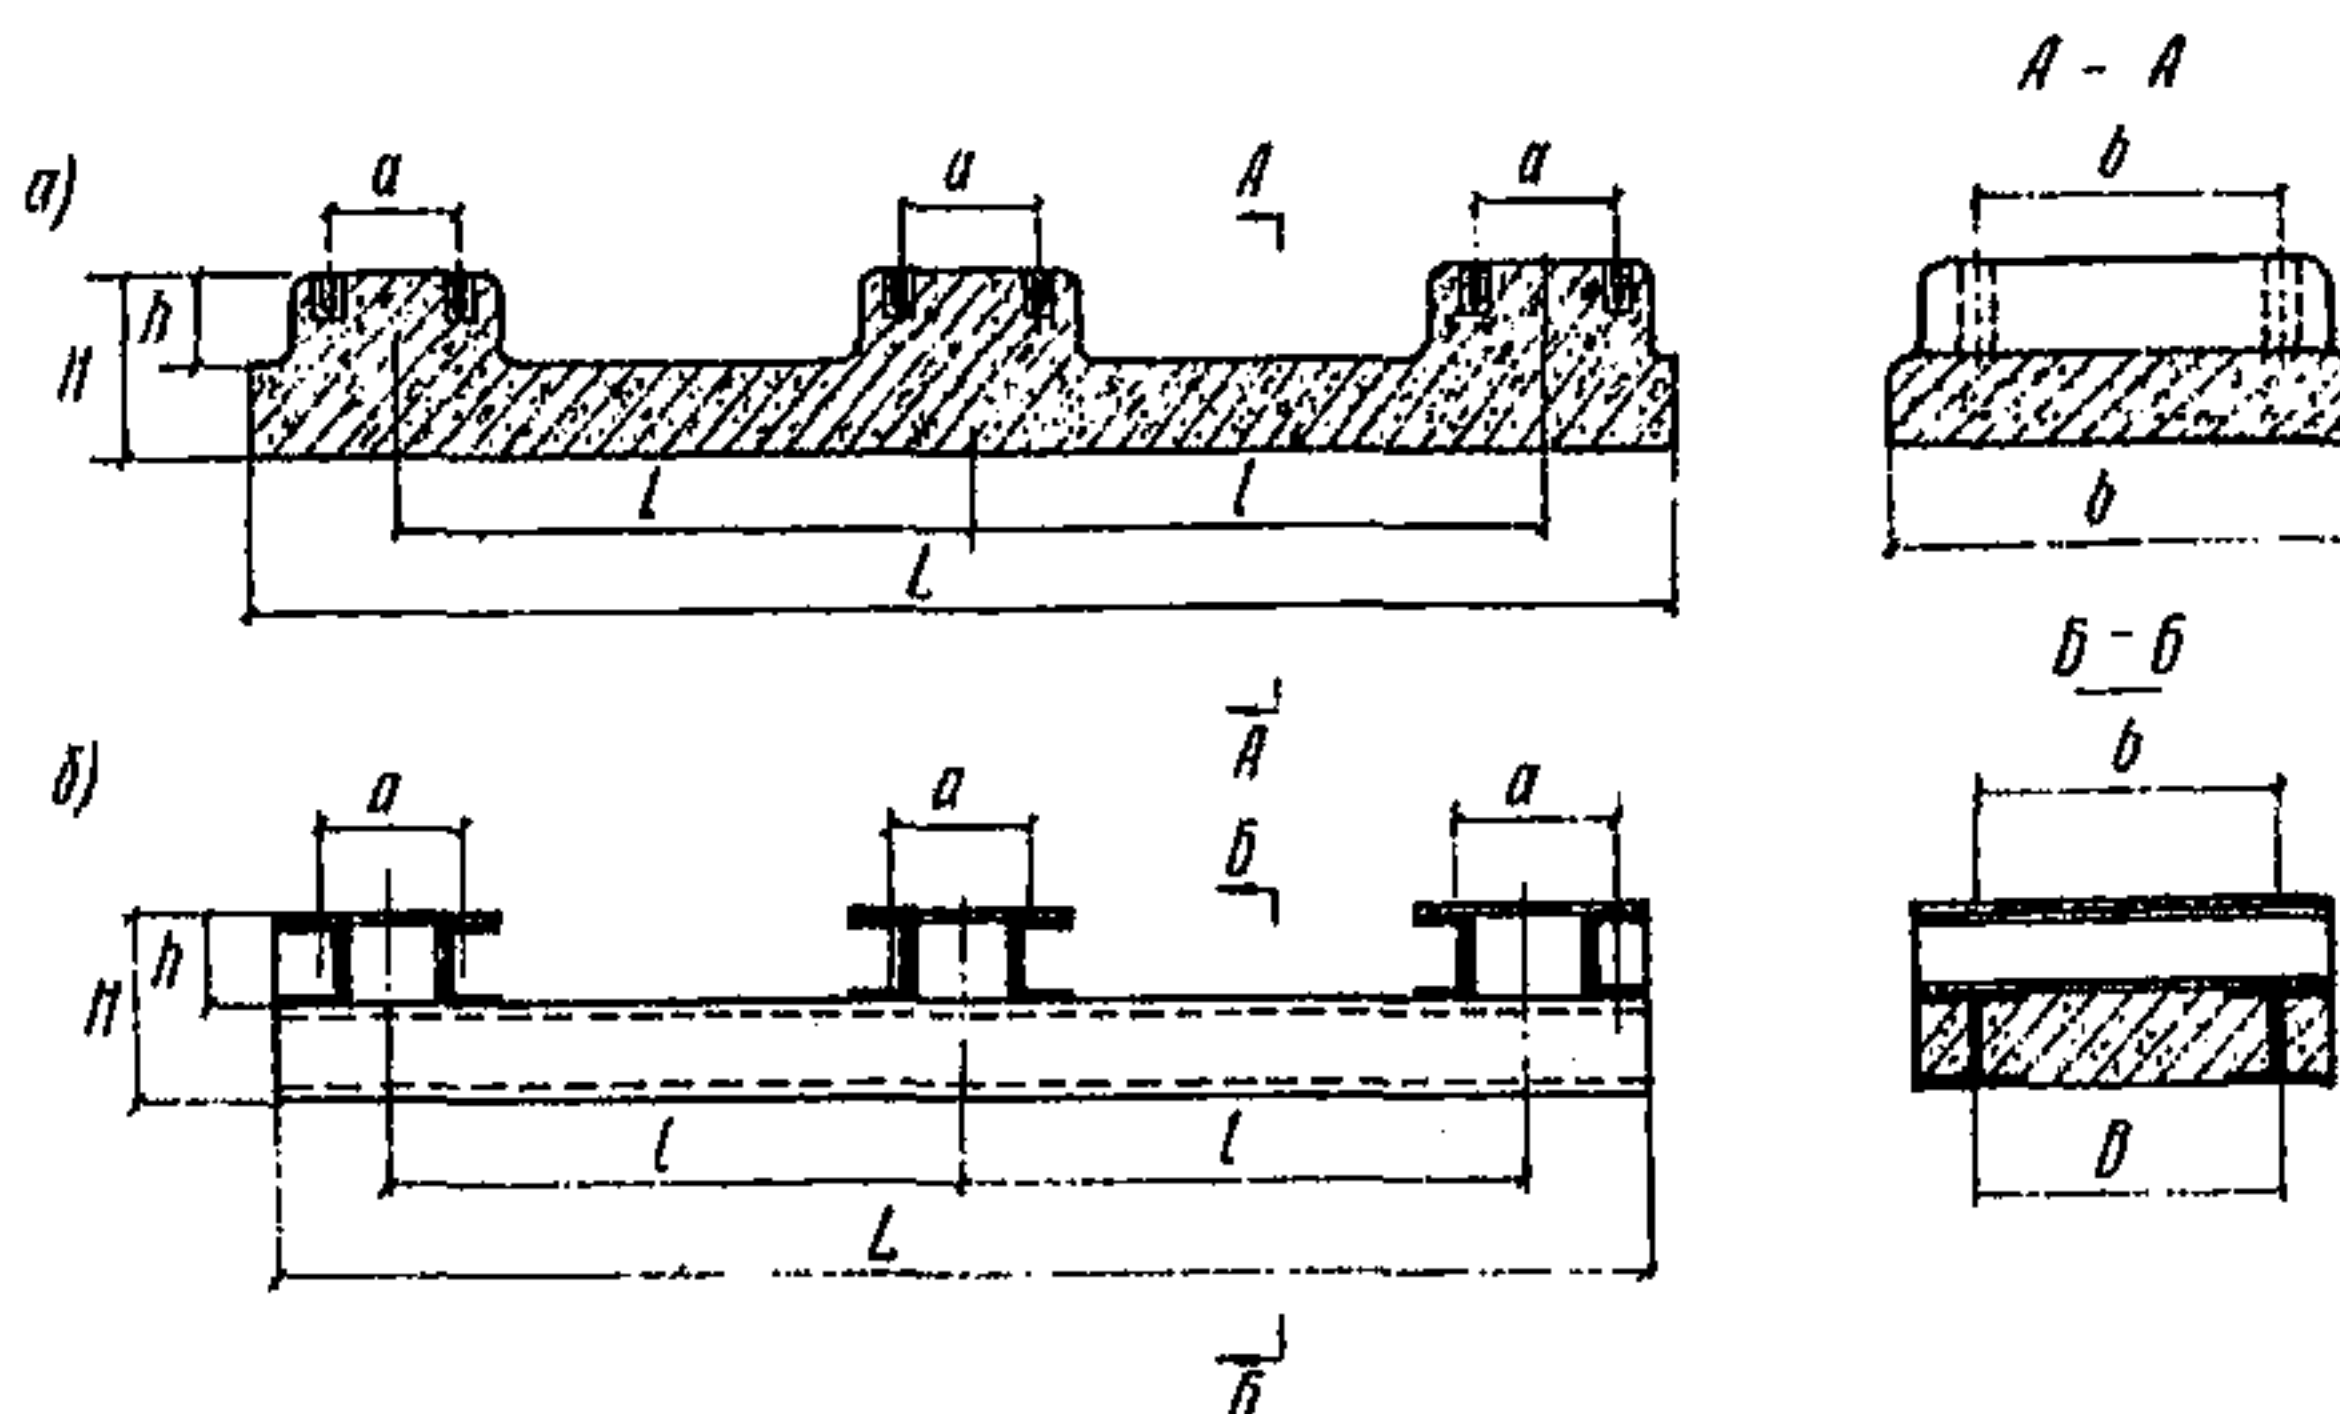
Рис. I. Типы железобетонных опорных конструкций под крупные блоки оборудования
